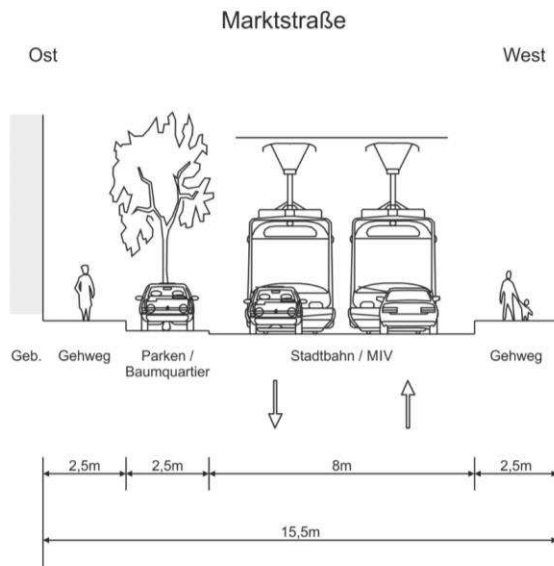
Querschnitt Marktstraße mit straßenbündigem Bahnkörper
